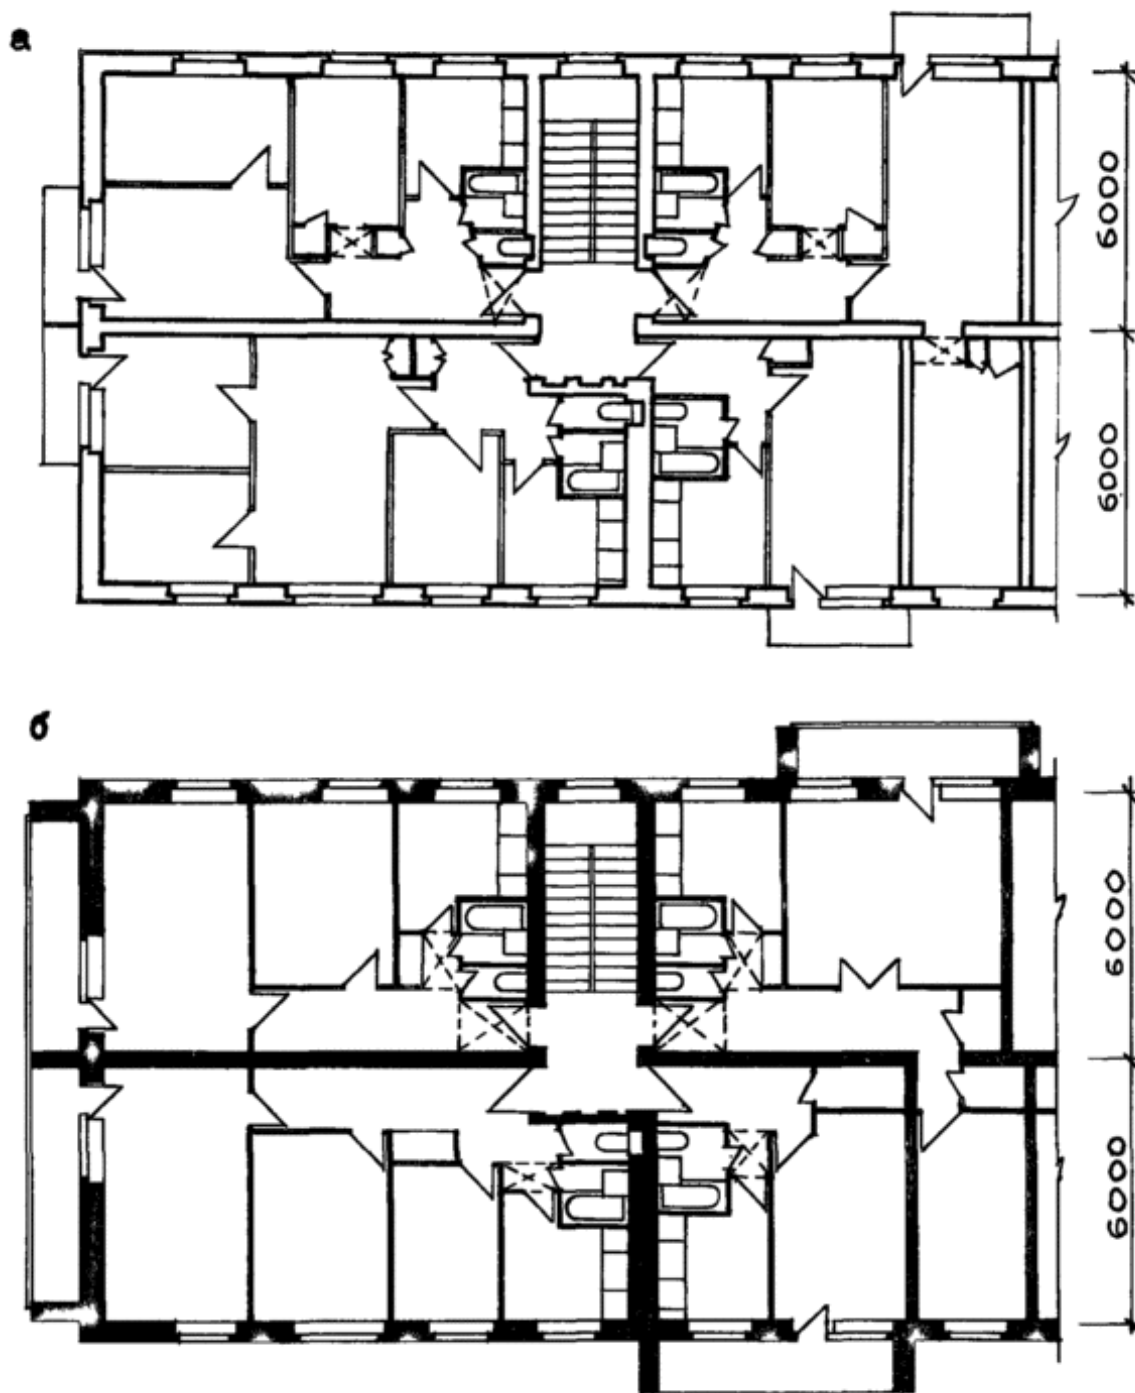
Планировка торцевой секции кирпичного дома серии 1-447 с продольными несущими стенами: а – до перепланировки, б- после перепланировки.
